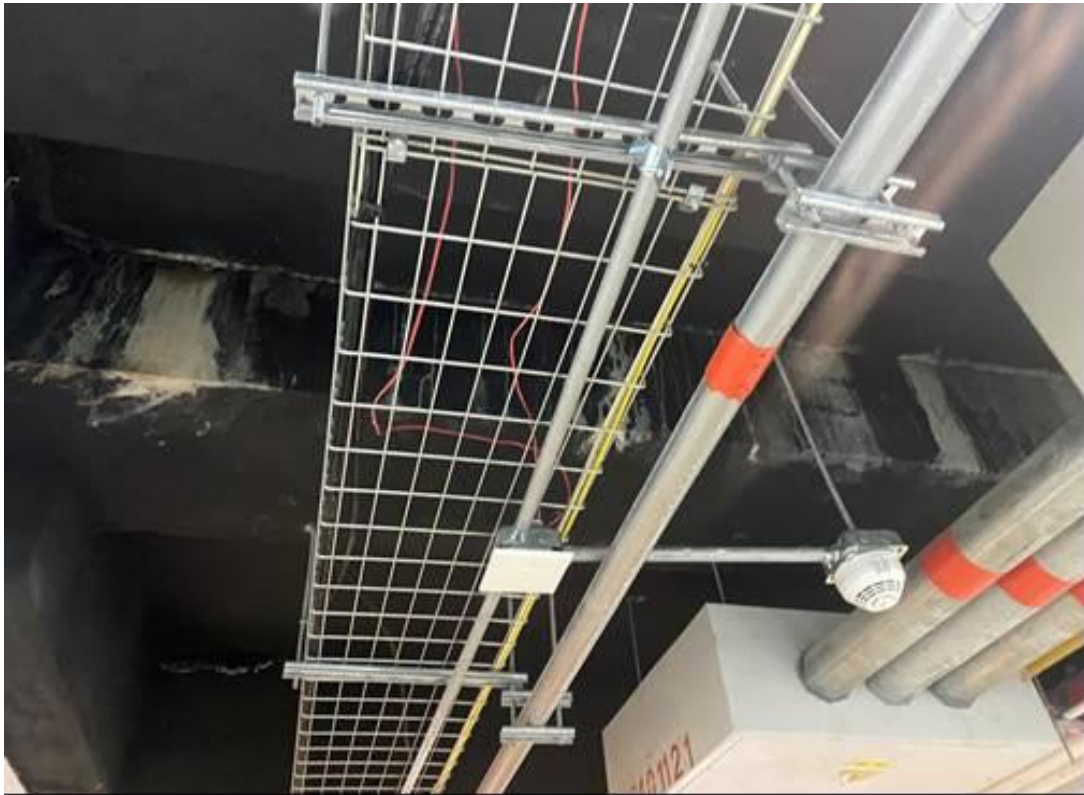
Ingreso de agua por fisura entre placa y viga torre 2
